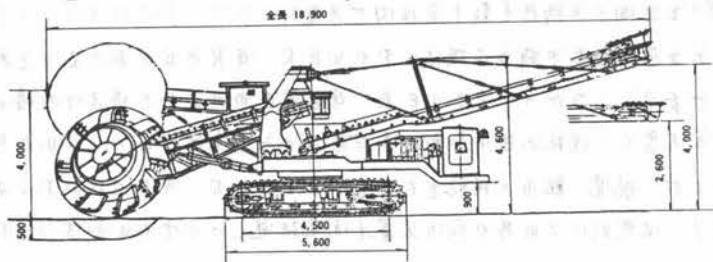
、表-1、図-1に掘削機の仕様および概要を示す。
